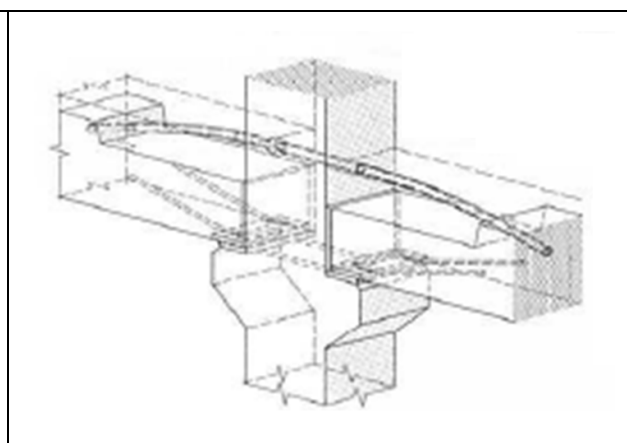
Ligação por consola curta de betão e pré-esforço (Stupré, 1981)
